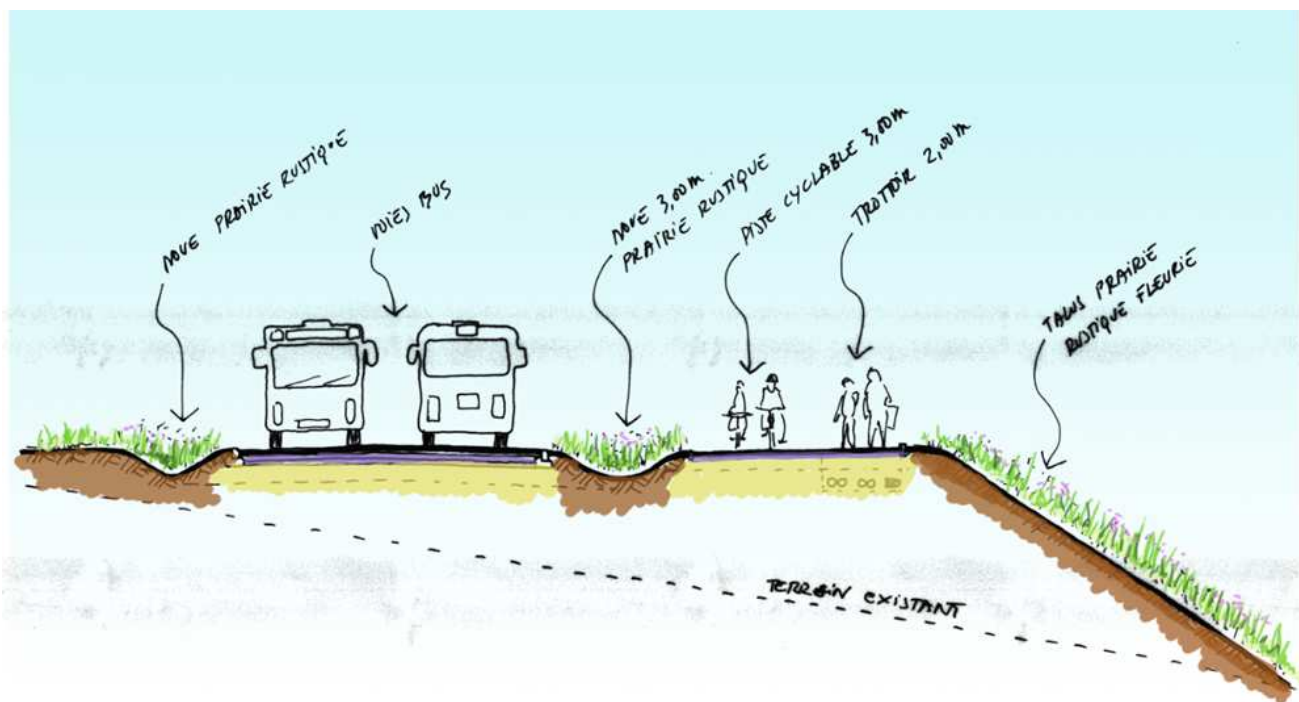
Coupe transversale de la voirie illustrée au niveau de la prairie (dossier PRO)
